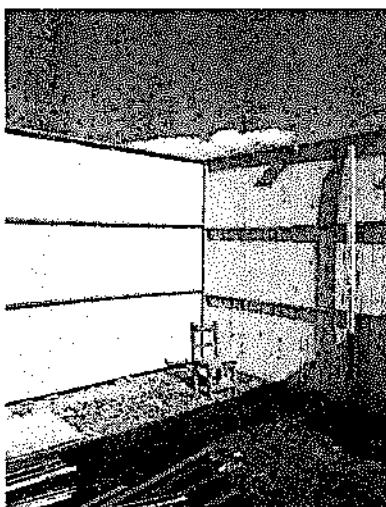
Vista del interior de las aulas de madera del pabellón 05
